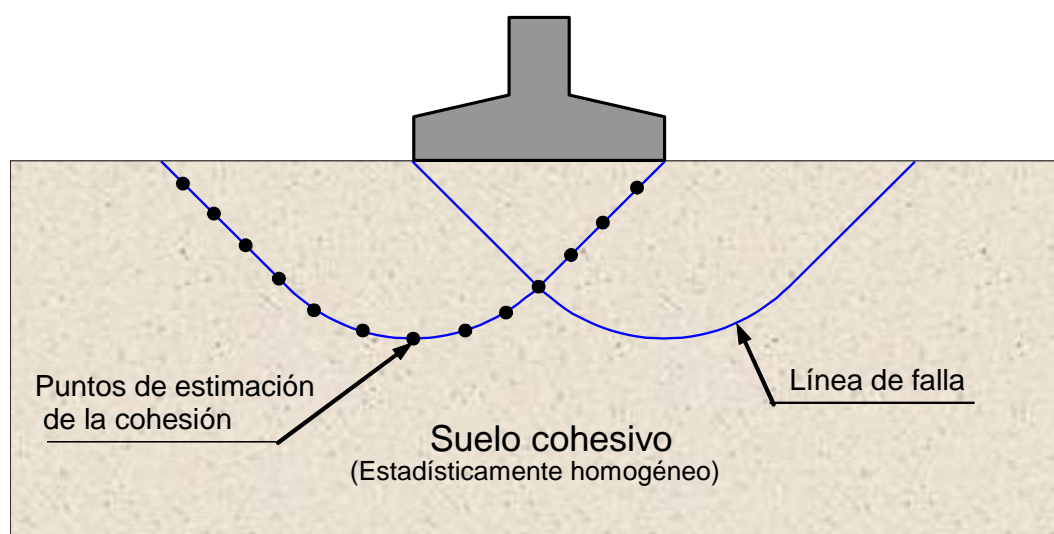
Zapata de cimentación (Auvinet, 2002).
